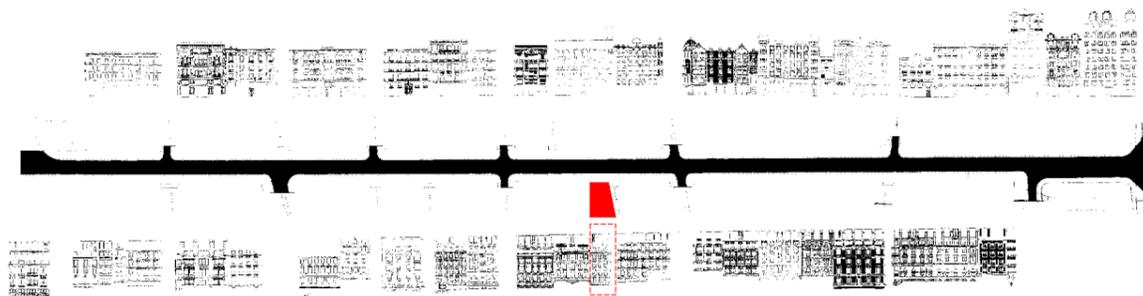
Planta Calle de la Paz y Alzados de los edificios.
